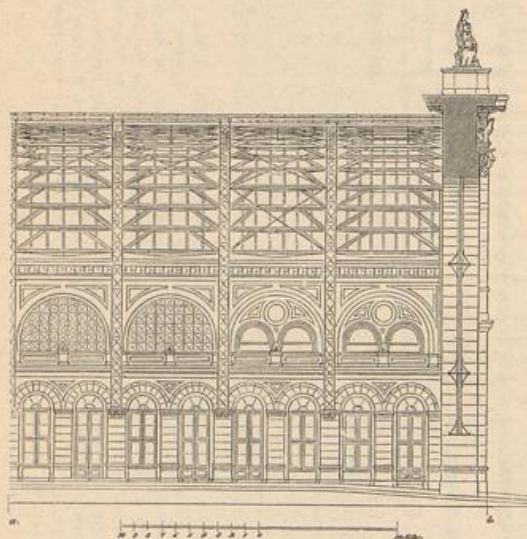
Empfangsgebäude der Berlin-Lehrter Bahn. Theil des Längenschnittes durch die Halle. (Maasstab 1:500.)
